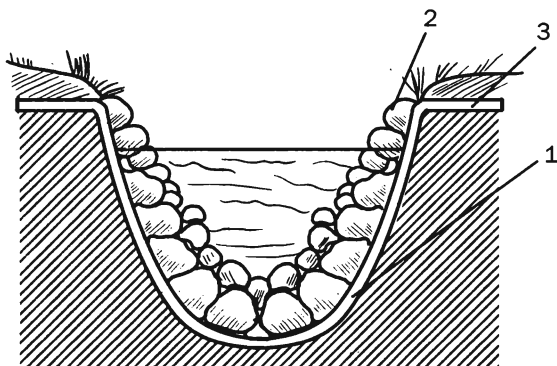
Формирование русла ручья: 1 — полиэтиленовая пленка или другой вид гидроизоляции; 2 — гравий; 3 — крепление края гидроизоляционной пленки
